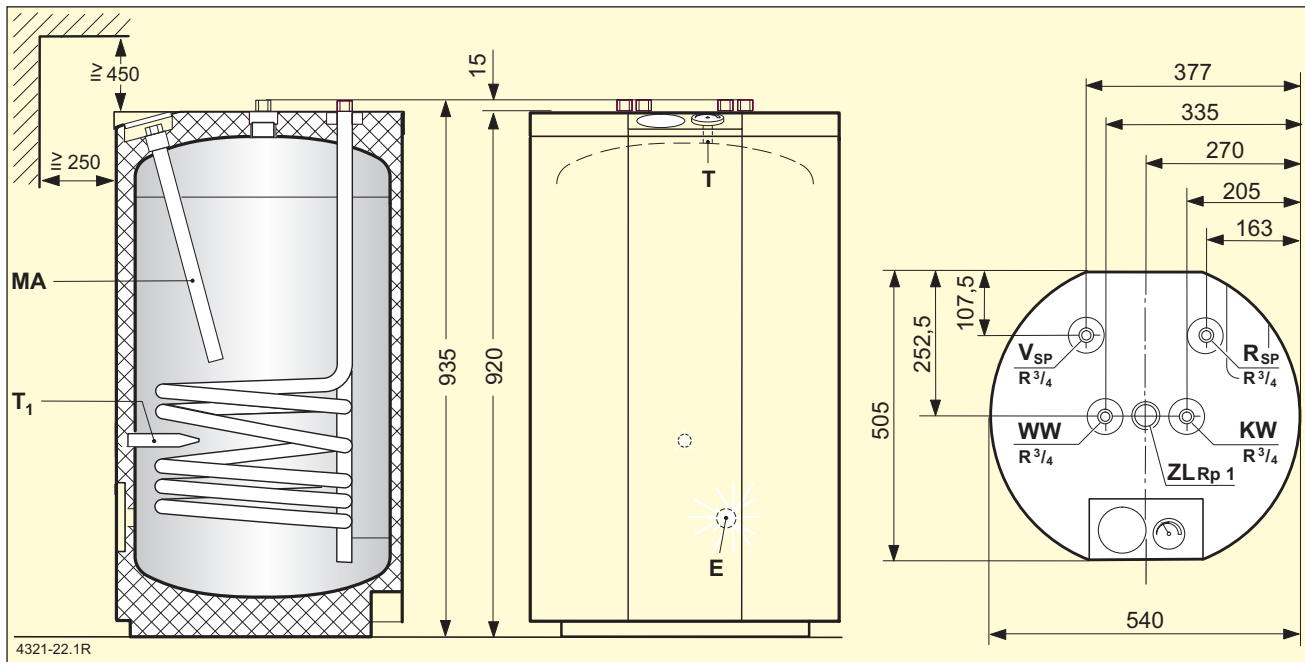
Bau- und Anschlussmaße ST 120-1 Z
